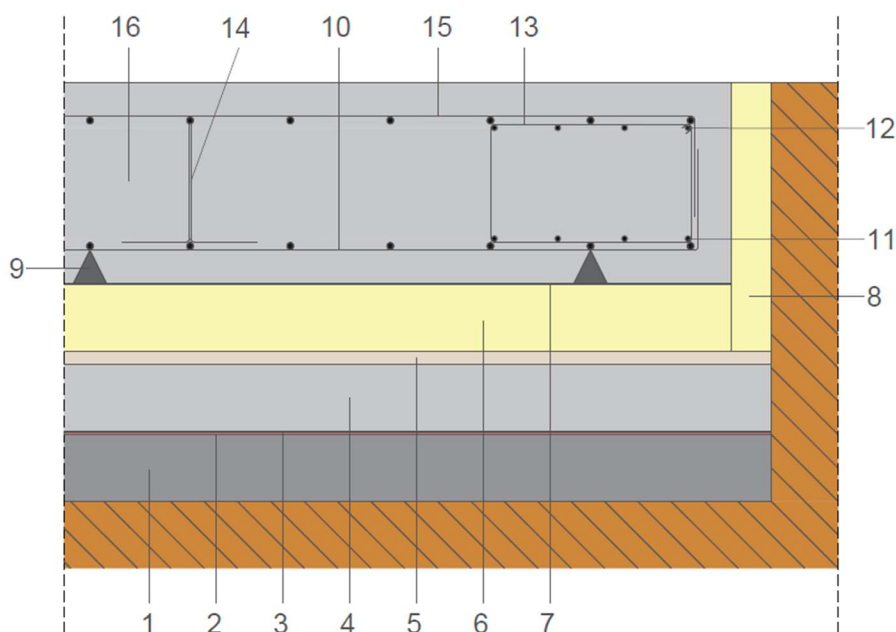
Detalle losa de cimentación. 2025. Fuente: Elaboración propia.
